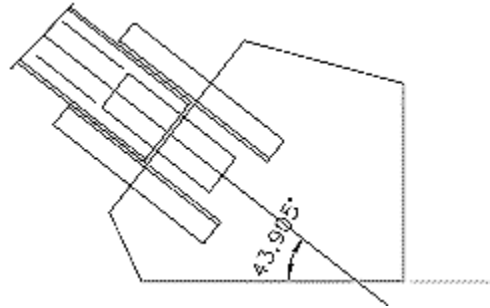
Conexión placa Gusset y ángulo de arriostre. Fuente: Propia realizado en AUTOCAD.
